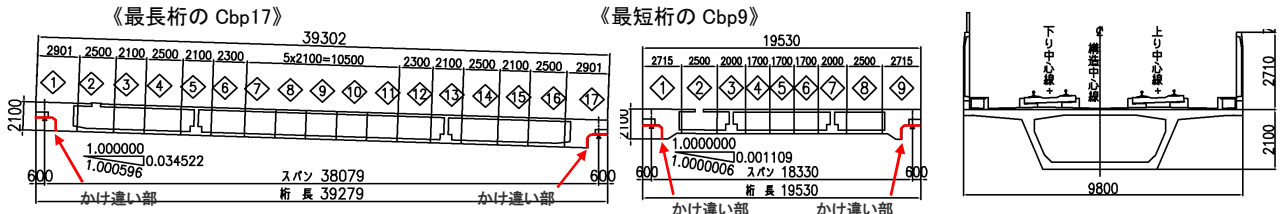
PC桁の構造図 (ブロック割り) と標準断面図
